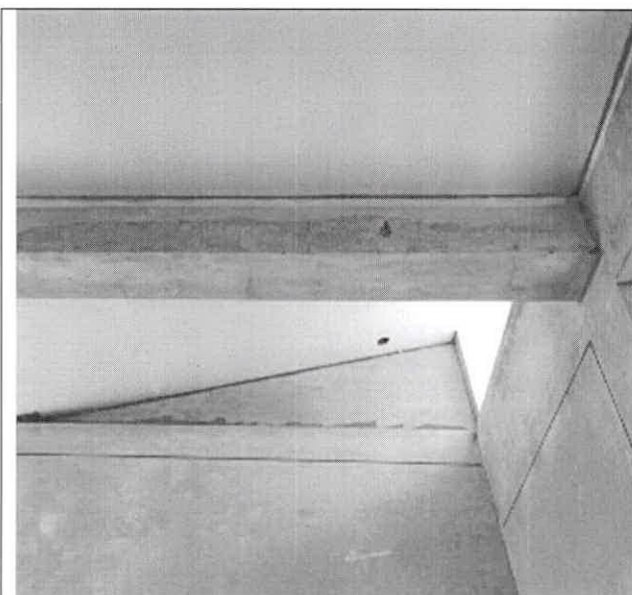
Vista interna de la viga del sector E2, se observa fisuras en las vigas peraltadas.
